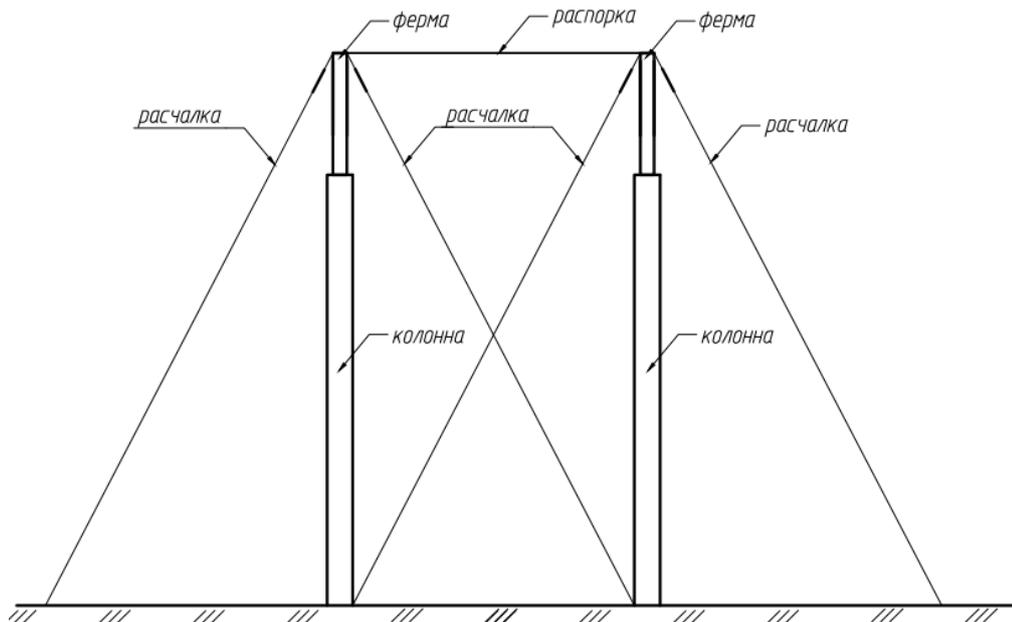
Установка и раскрепление первых двух стропильных ферм
